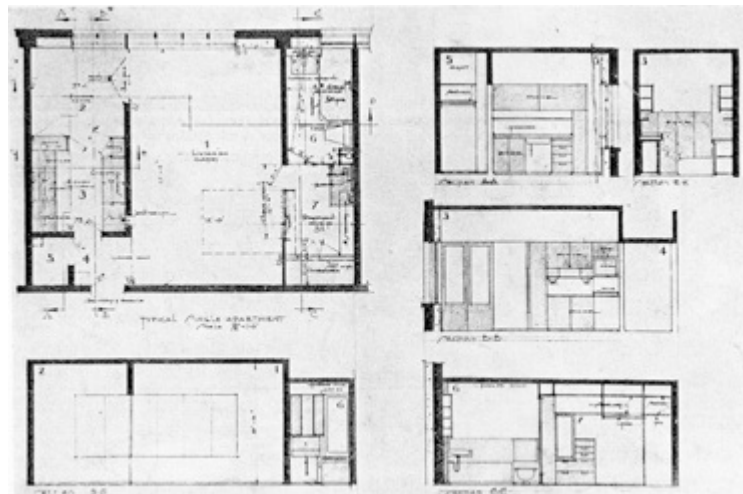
Distribución en planta de un apartamento y secciones de cocina, baño y vestier.
